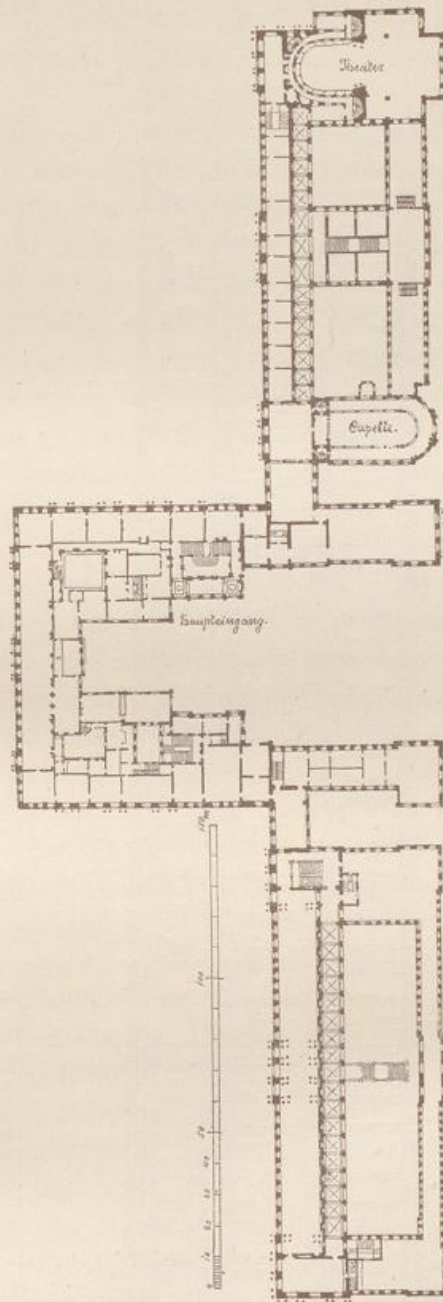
Schloss von Versailles, Grundriss.
